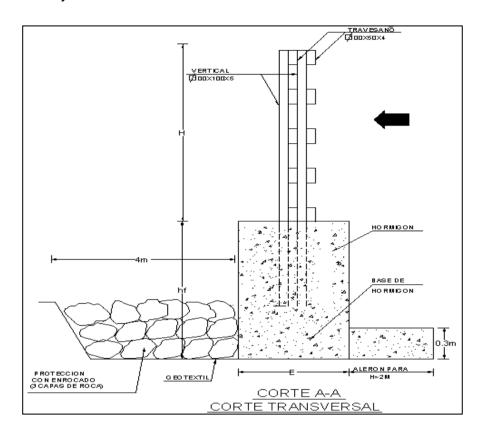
Muro con Enrejado Metálico Tipo Peineta de Viguetas Prefabricadas Corte A-A Fuente: J. Lema
